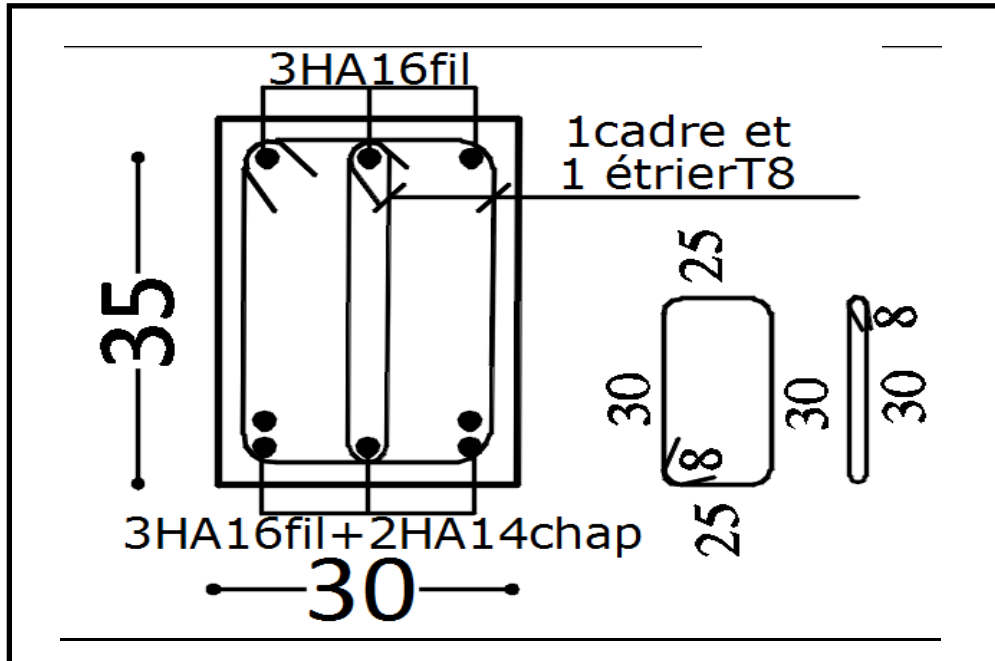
Ferrailage en travée d'une poutre principale.
